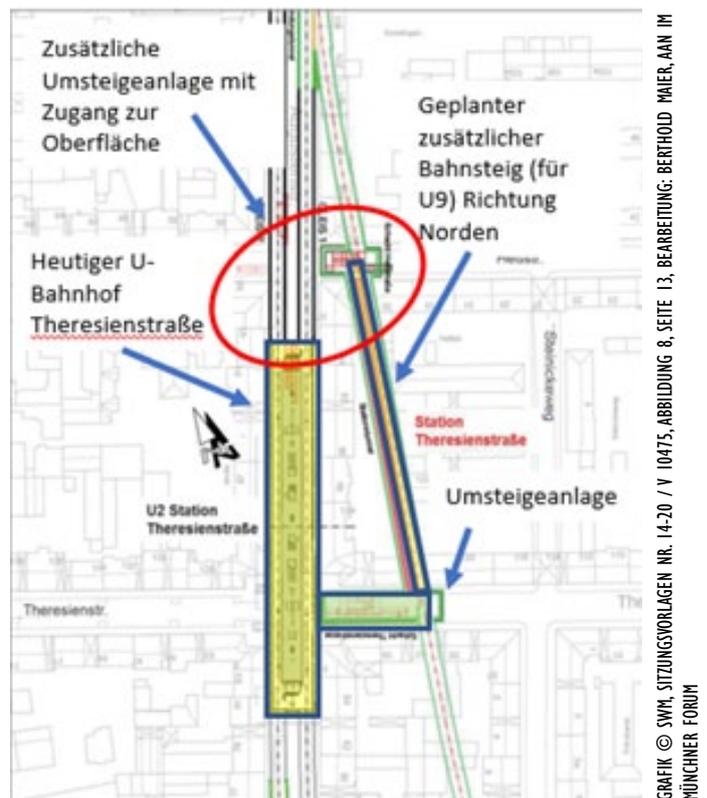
Planung Erweiterung U-Bahnhof Theresienstraße
